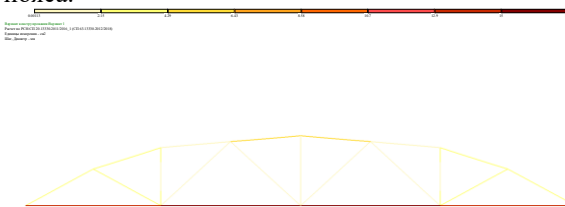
Расчетное армирование нижнего пояса фермы до пожара
